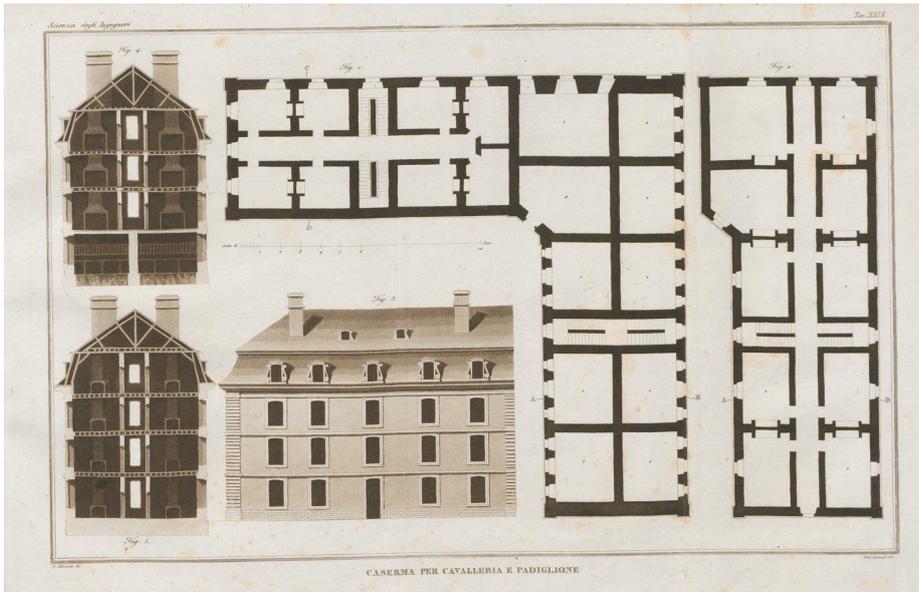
TAV XXVIII Facade d'un corps de casernes et d'un pavillon d'officiers avec plan. Belidor, La Science des ingénieurs... nell'edizione di C.L.M.H. Navier, 1832, La scienza degli ingegneri nella direzione delle opere di fortificazione e d'architettura civile di Belidor / con note del Signor Navier; versione italiana di Luigi Masieri, fratelli Negretti, Mantova
